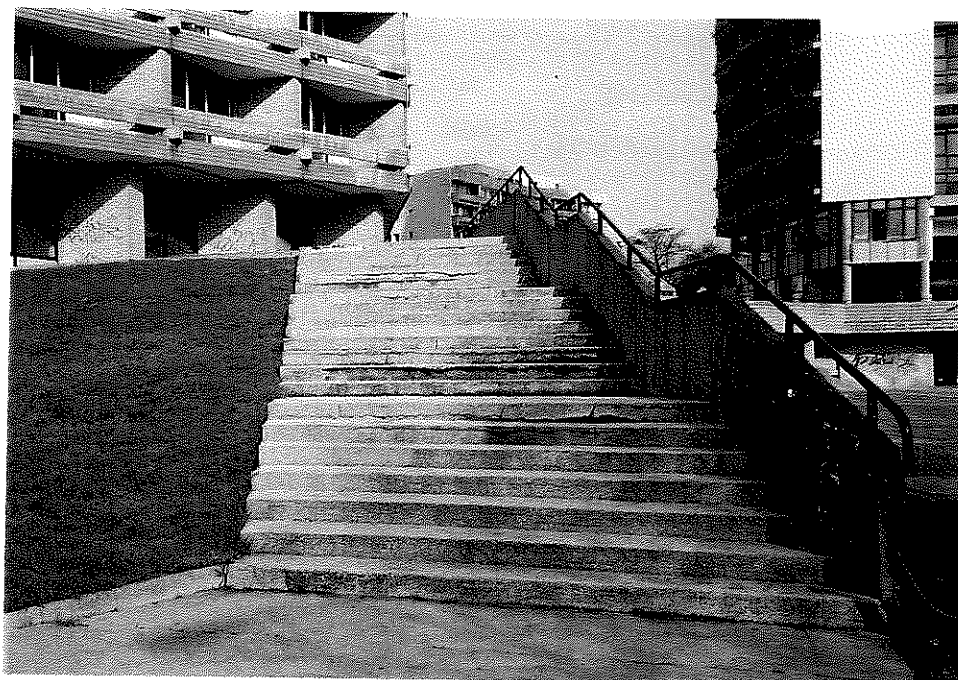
Elewacja tylna tarasów – ogólny widok od strony ul. Sienkiewicza.
